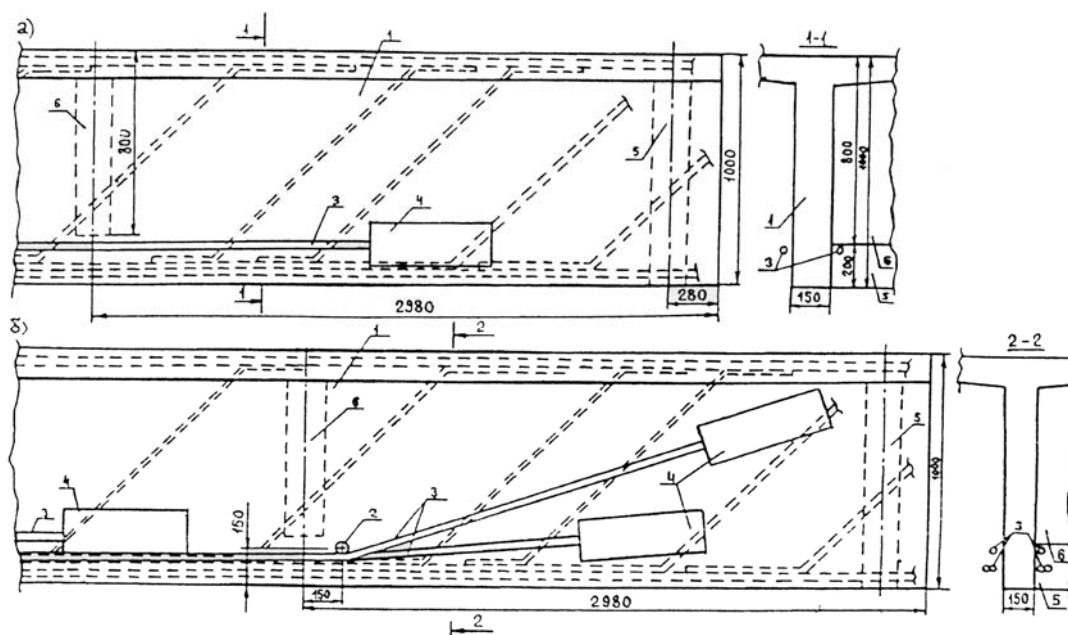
Схема усиления балок с ненапрягаемой (каркасной) арматурой двумя (а) и четырьмя или шестью (б) пучками: 1 – усиливаемая балка; 2 – отгибающее устройство диаметром 80 мм; 3 – пучок из арматурного каната класса К-7; 4 – бетон омоноличивания упора, основного и дополнительного анкеров; 5 и 6 – имеющиеся у балки соответственно концевая и промежуточная диафрагмы. Размеры даны в миллиметрах
